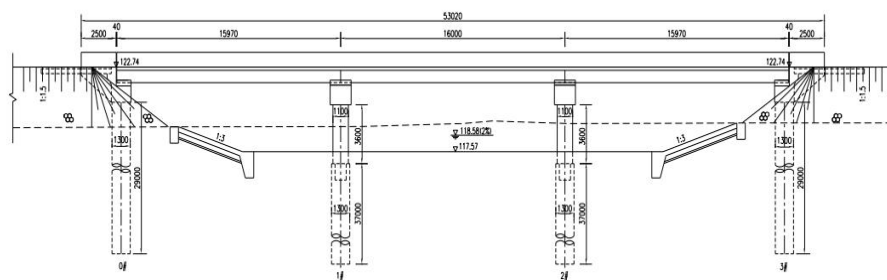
大河刘沟 1#桥梁纵立面图（单位：尺寸 mm，高程 m）
